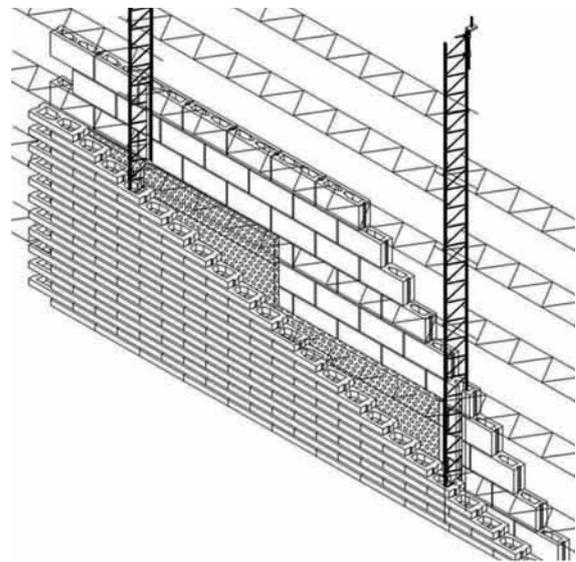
Muro capuchino con el Sistema de Albañilería Integral, con hoja exterior de ladrillo alargado, cámara de aire con aislamiento entre cerchas y hoja interior con bloque de hormigón hueco, y fijaciones superiores en las costillas.
